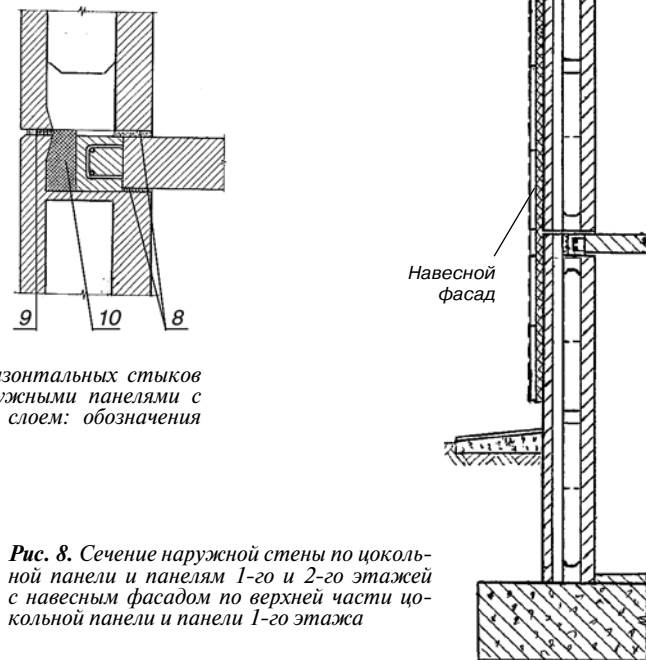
Сечение наружной стены по цокольной панели и панелям 1-го и 2-го этажей с навесным фасадом по верхней части цокольной панели и панели 1-го этажа
